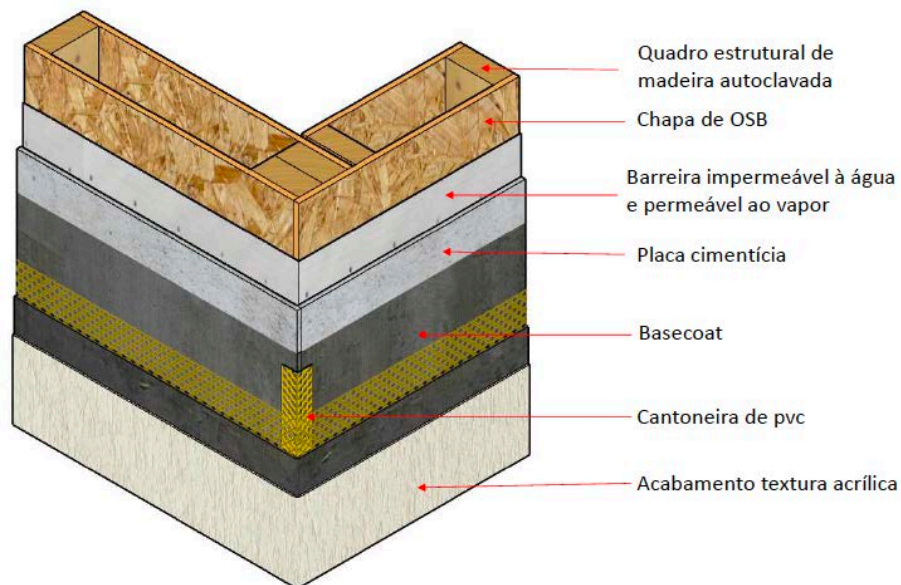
Ilustração da cantoneira de PVC aplicada sobre as placas cimentícias.
